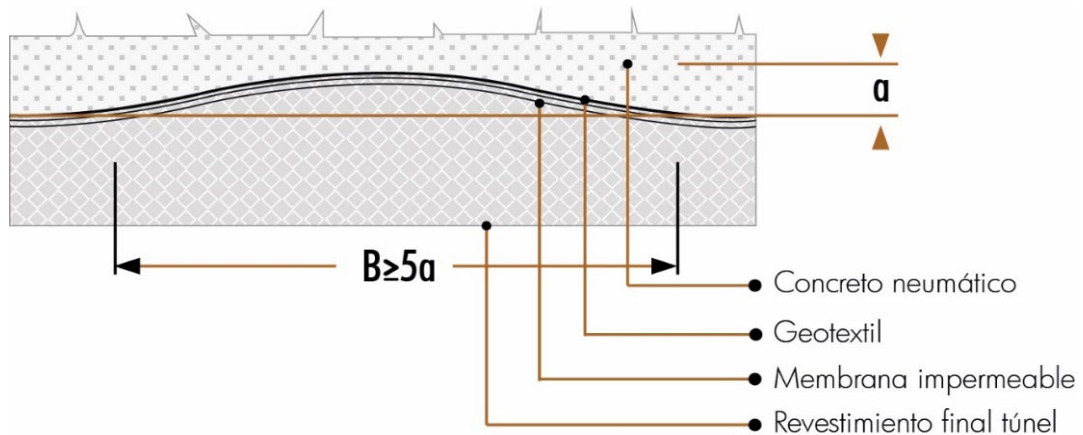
Tolerancia máxima de rugosidad para la instalación de la membrana impermeabilizante
